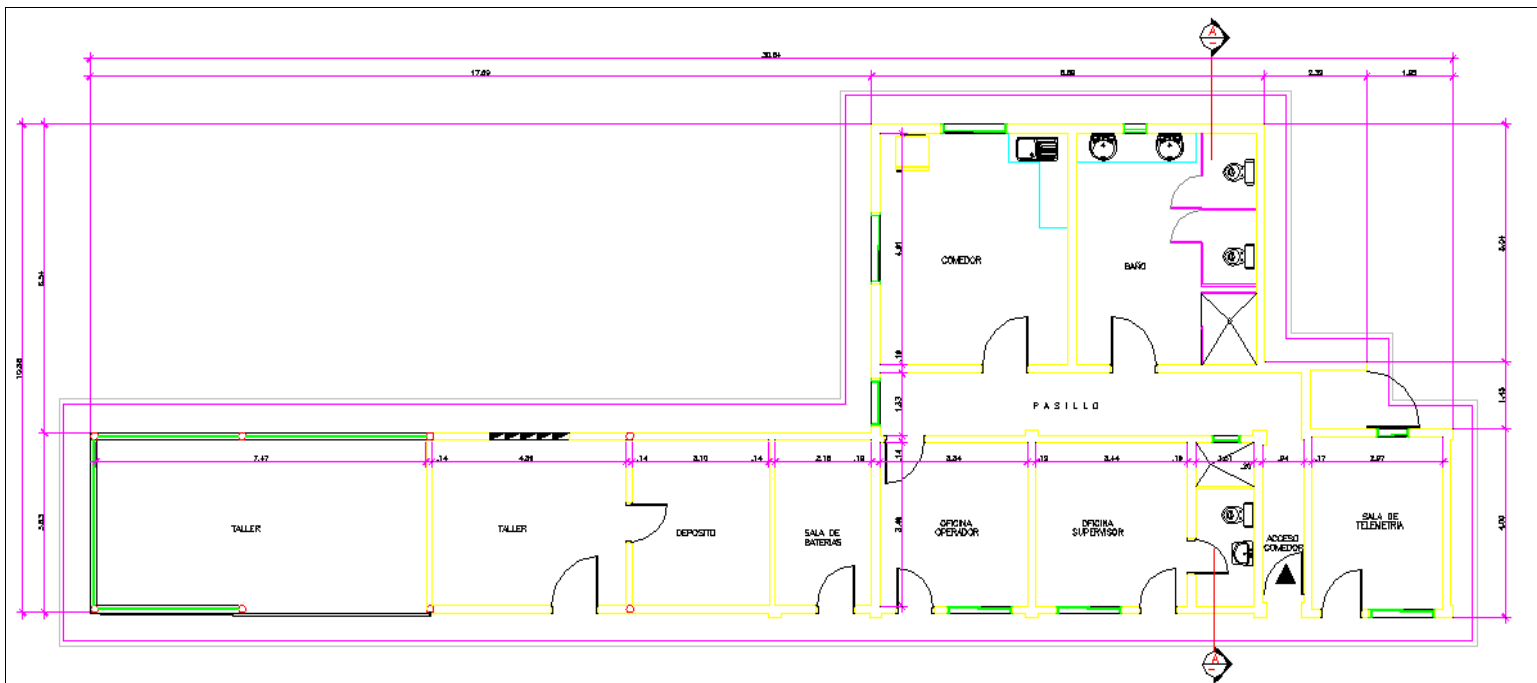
Vista en planta de la infraestructura de la Planta Compresora Budare.
